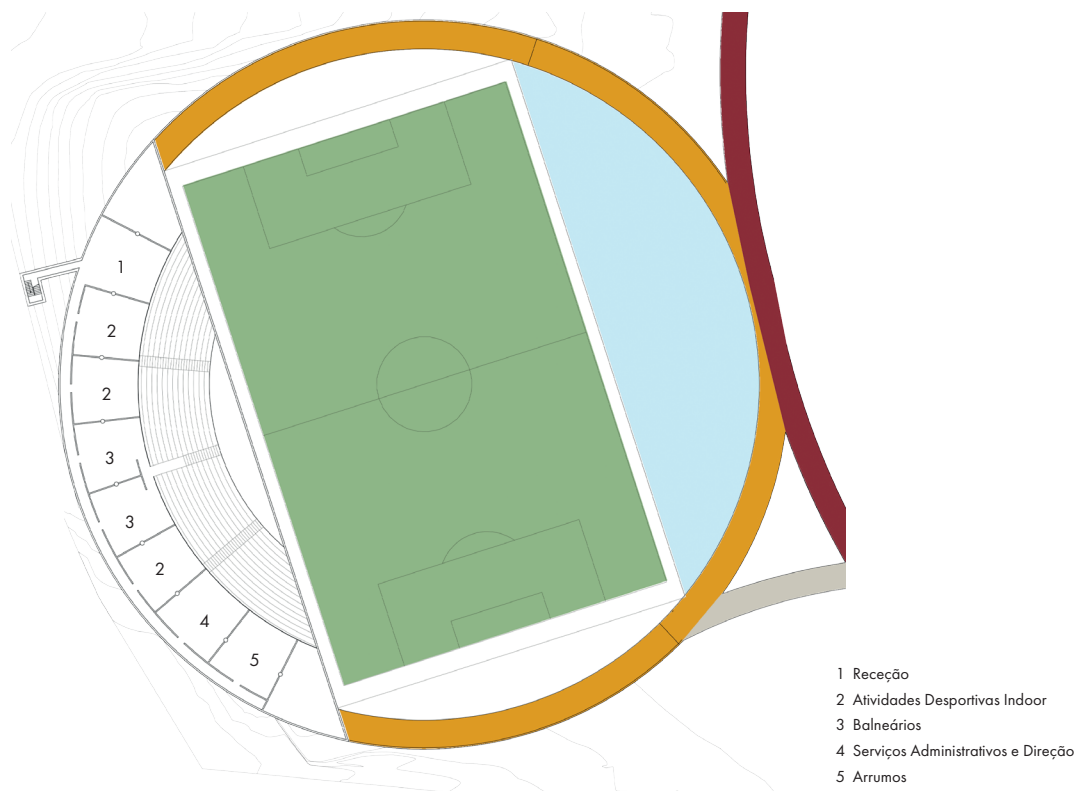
Planta do piso -1 do estádio. Realizado em CAD pela autora.
